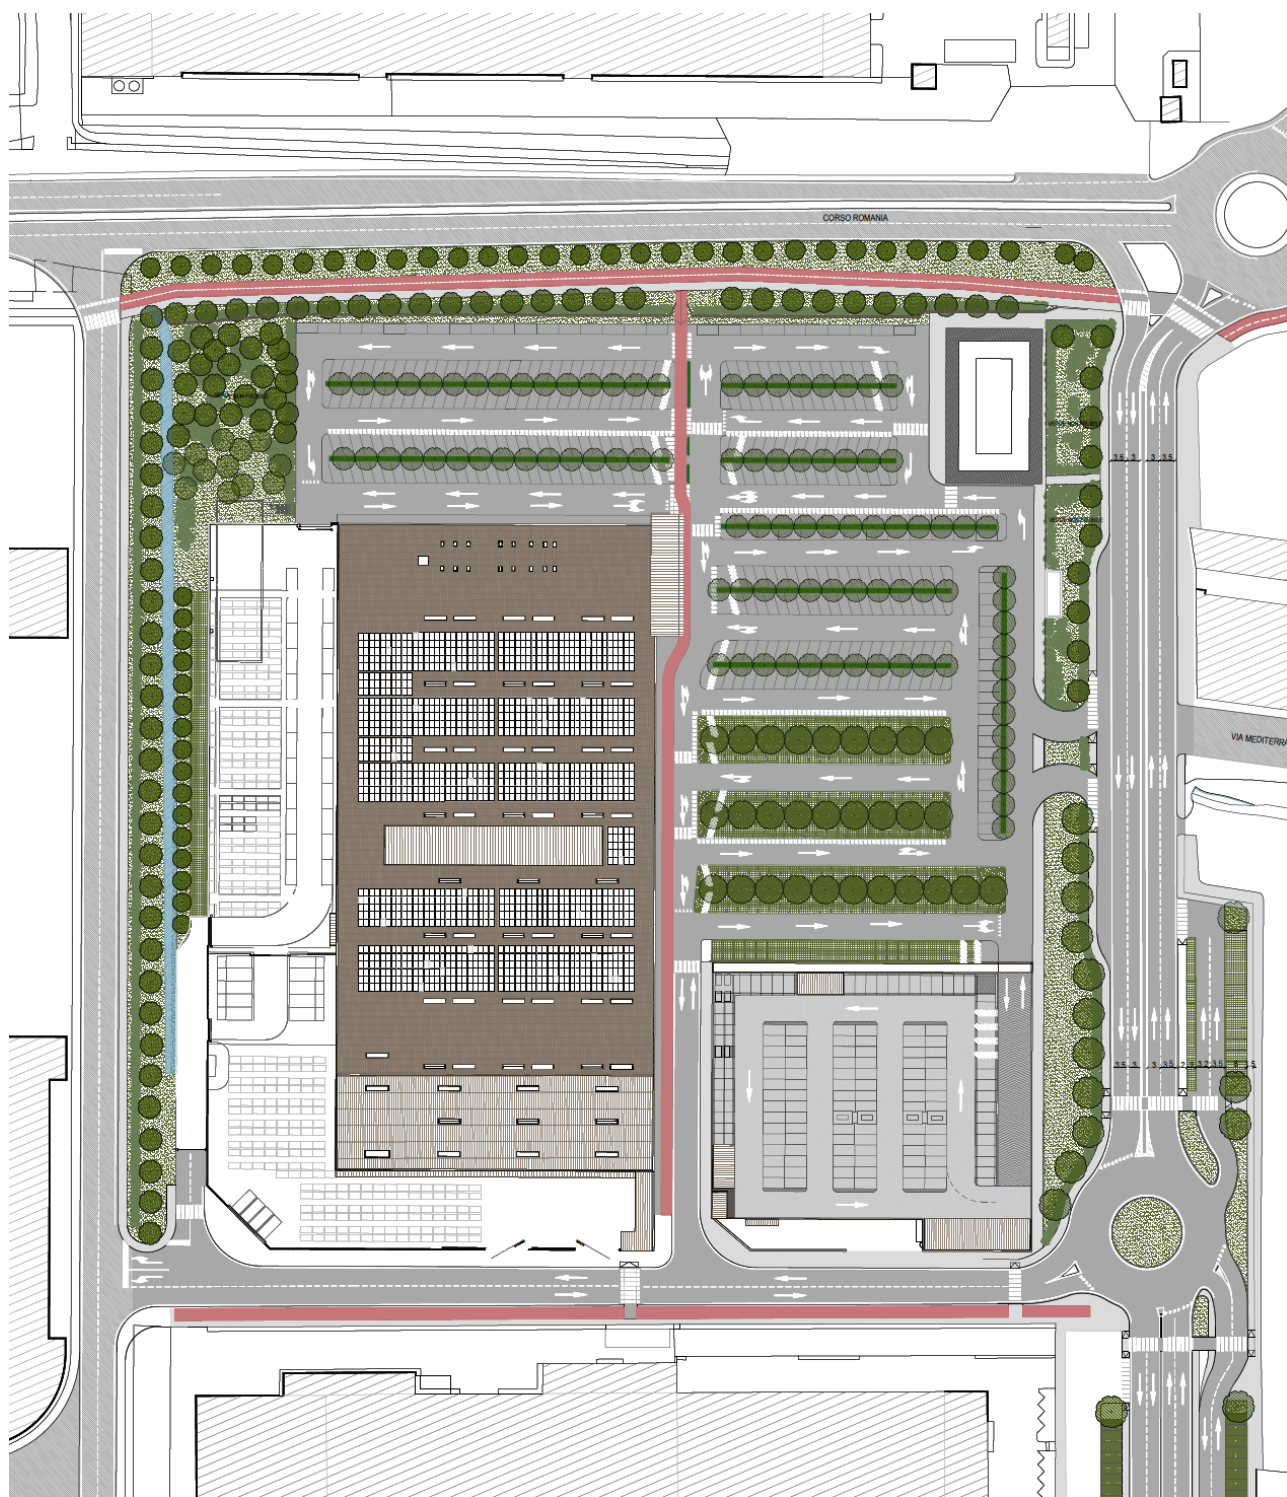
Planimetria generale di progetto – Nuova configurazione progettuale
